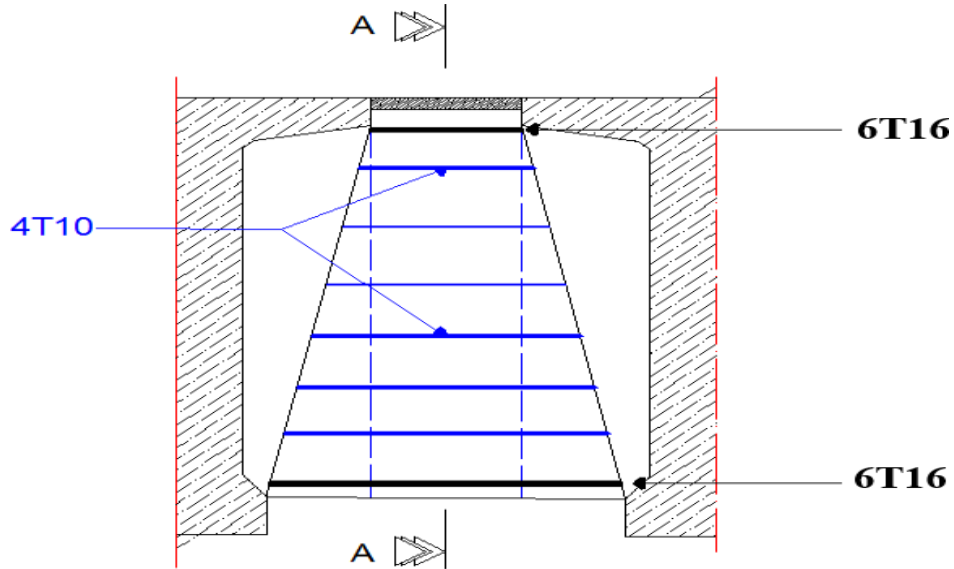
coupe longitudinale de ferrailage de l'entretoise d'about
